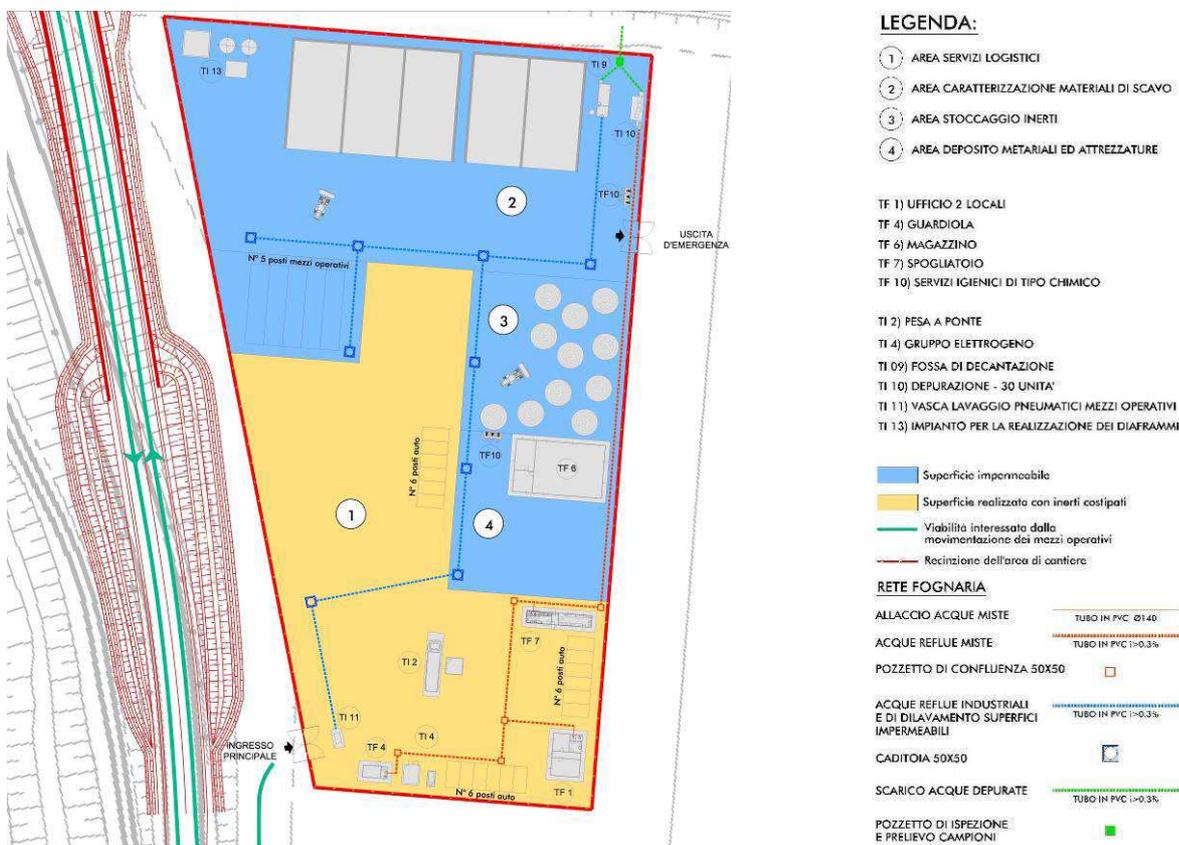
LAY-OUT DEL CANTIERE A-T (ESTRATTO DALL'EAB. T00CA00CANLF01A- TAV. 18.1).
